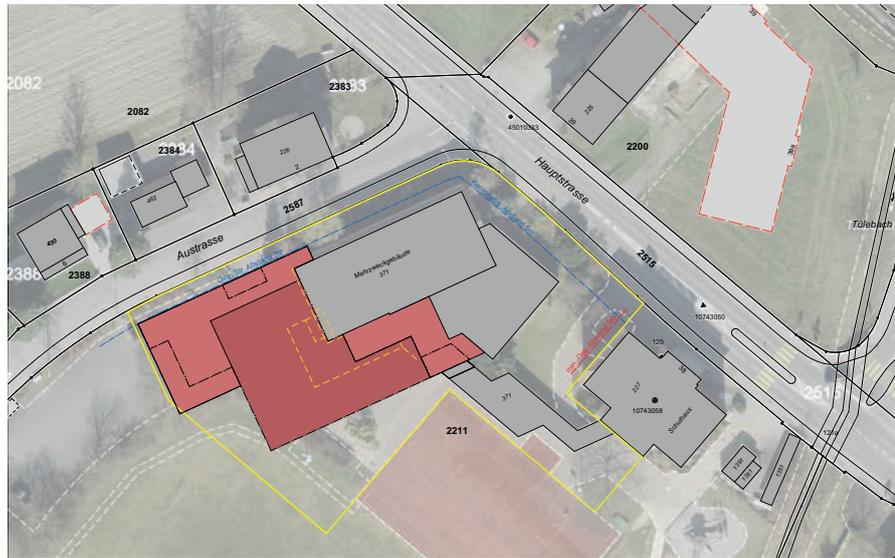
Situation, Grobdispo - Variante 2, 9.4.25 (Hinweis: Vergrößerung siehe Planbeilage)
